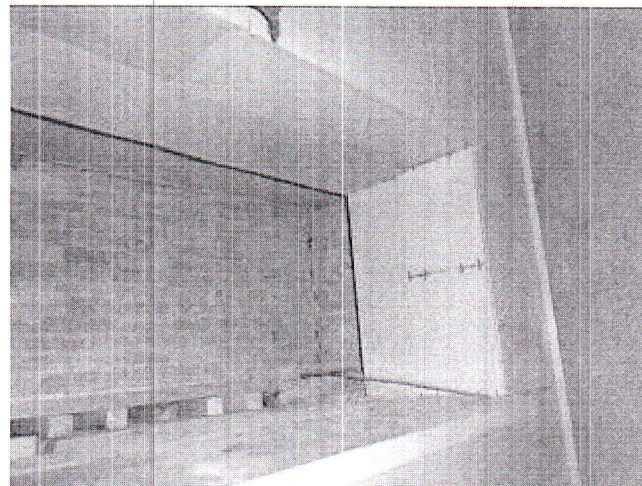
Б. Фрагмент образца фасада до испытания по ГОСТ 31251-2008.
